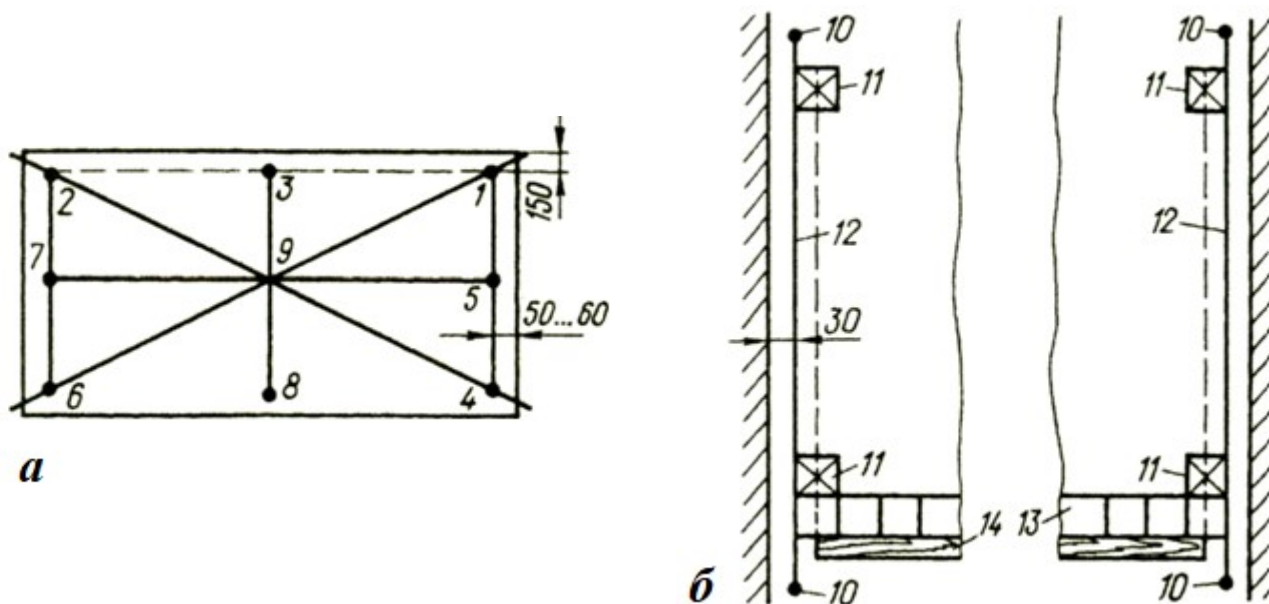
Підготування поверхні для облицювання: а - схема провішування поверхні; б - схема влаштування облицювання; 1...9 - цвяхи; 10 - металеві штирі; 11 - маякова плитка; 12 - шнури; 13 - нижній ряд плиток; 14 - рейка на рівні чистої підлоги
